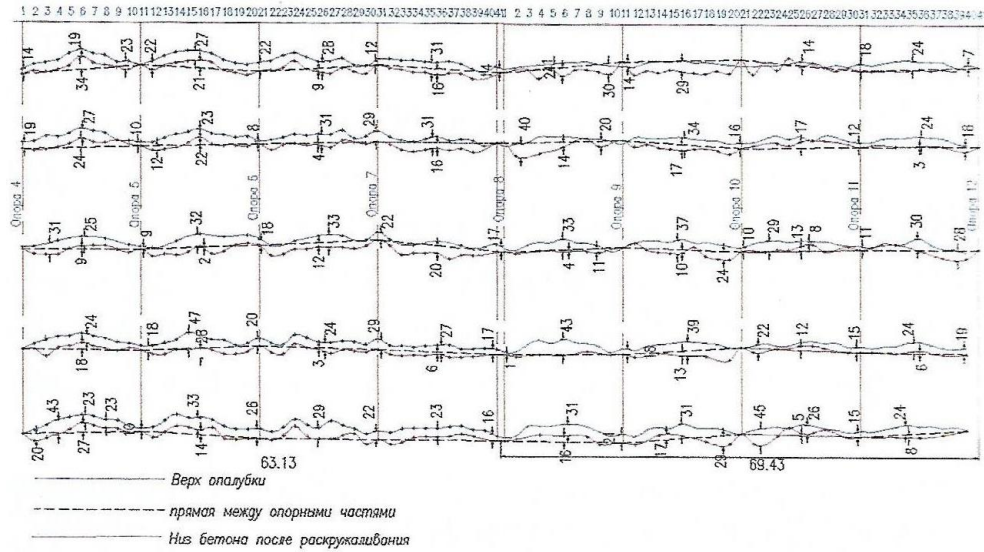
Графики положения верха опалубки и низа железобетонной плиты (величины просадок опалубки)
